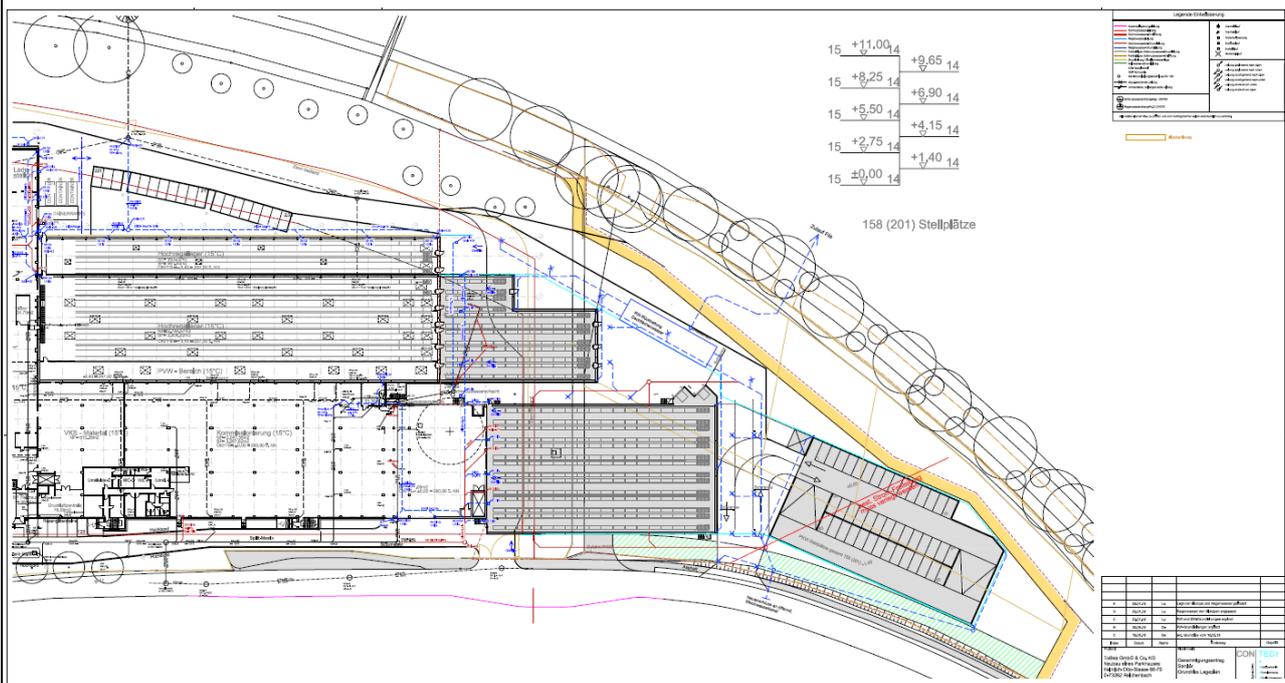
Entwässerungskonzeption Lageplan Stand 09.07.18 (INGENIEURBÜRO CON TEC GMBH)
